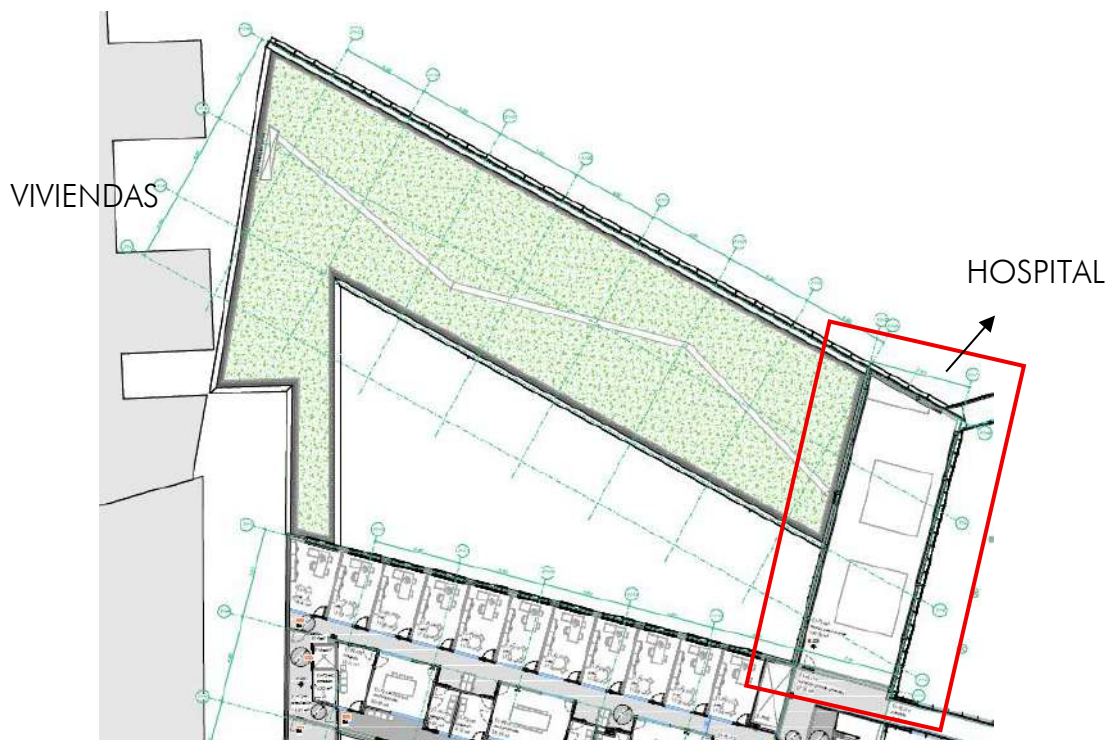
Instalaciones. Planta Segunda. Edificio 1
